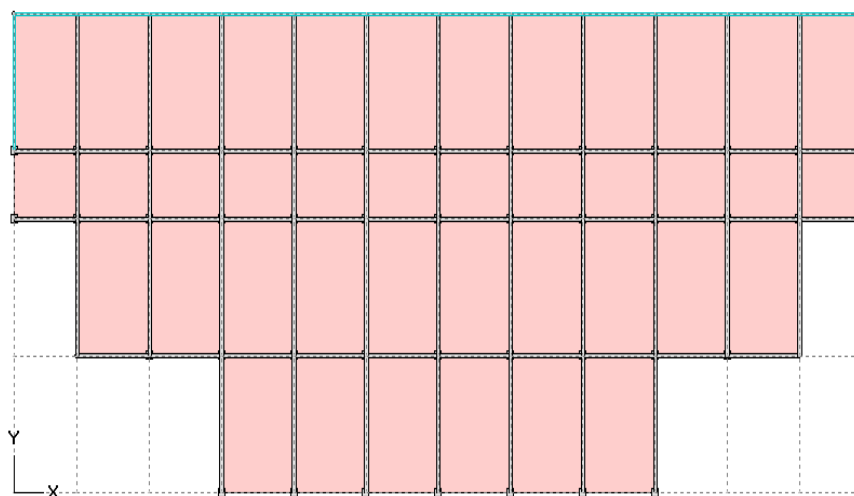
Площа арматури на 1 м. п. по осі Y у верхньої грані
